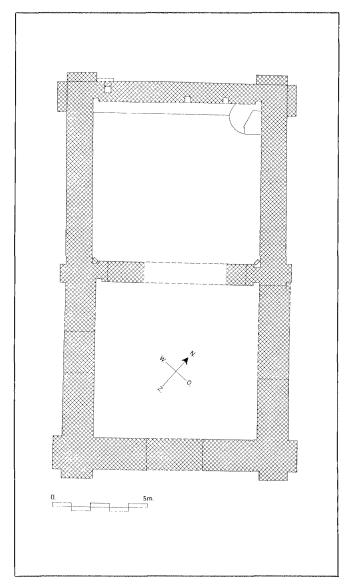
Plan du château de Starrenburg d'après les fouilles; xme siècle
